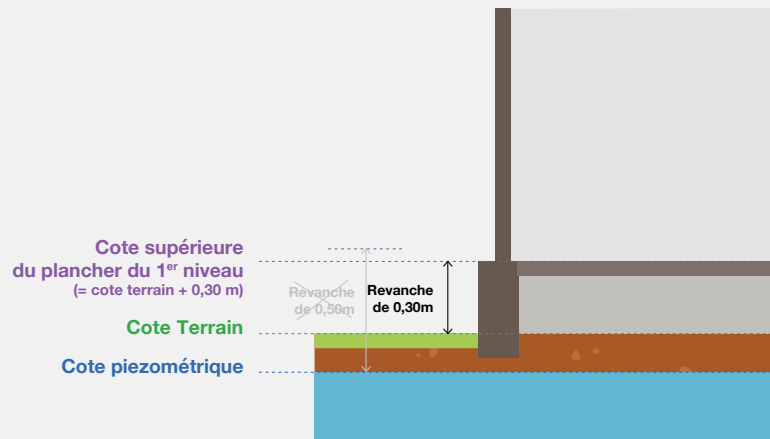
Cote du plancher du 1^{er} niveau = cote du terrain + 0,30 m (cas n°2).
